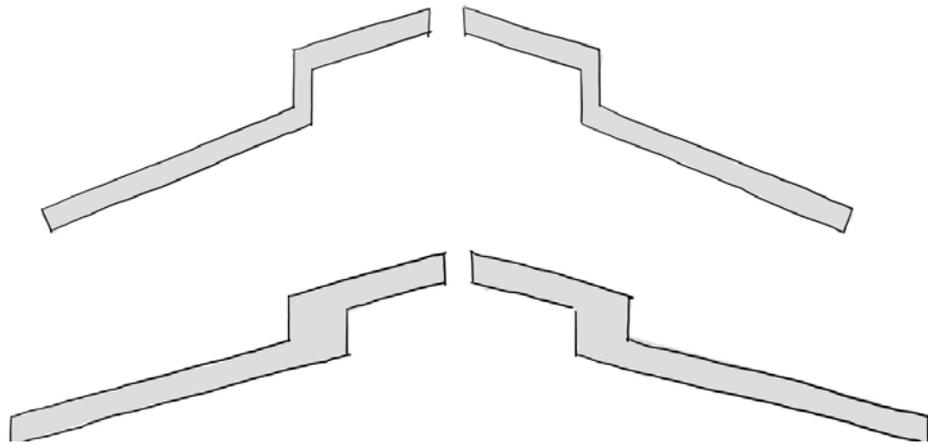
Bocetos cuya referencia está en unos planos (F.04 y F.05) del proyecto de Consolidación, labor de cerrajería en el apoyo estructura-muro de la fachada recta y oblicua. Estos planos están firmados por Eduardo de Miguel, Rafael Ferriols y Leandro Feliu en julio de 2015. En los dibujos adyacentes se diferencia el grosor del tramo vertical del chapón, el cual aumentaría según el espacio a cubrir en los mencionados huecos. Fuente: elaboración propia.
